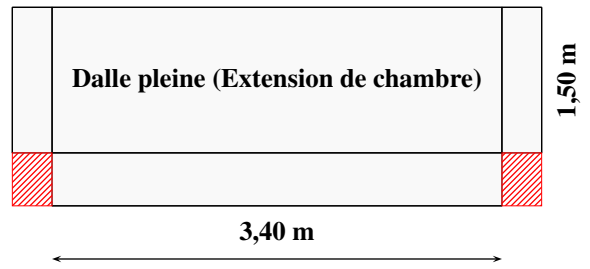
Dalle rectangulaire (Extension de chambre)
